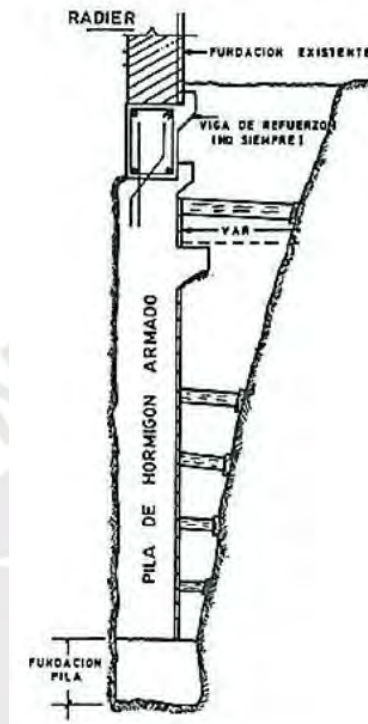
Proceso constructivo de pila de refuerzo. (Fuente: Pilotes Terratest. 2001)
